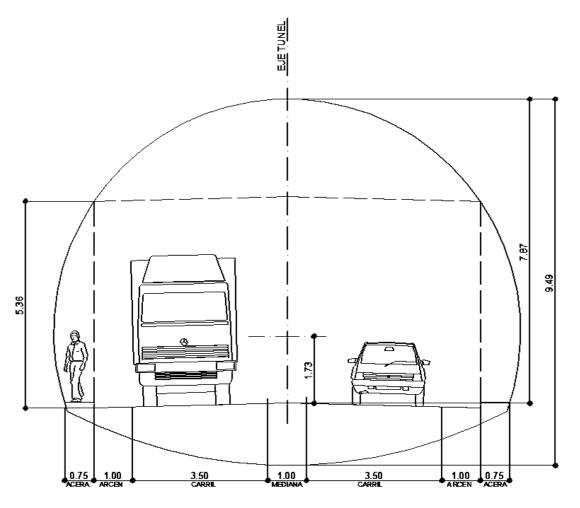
Sección transversal del túnel. Elaboración Propia
